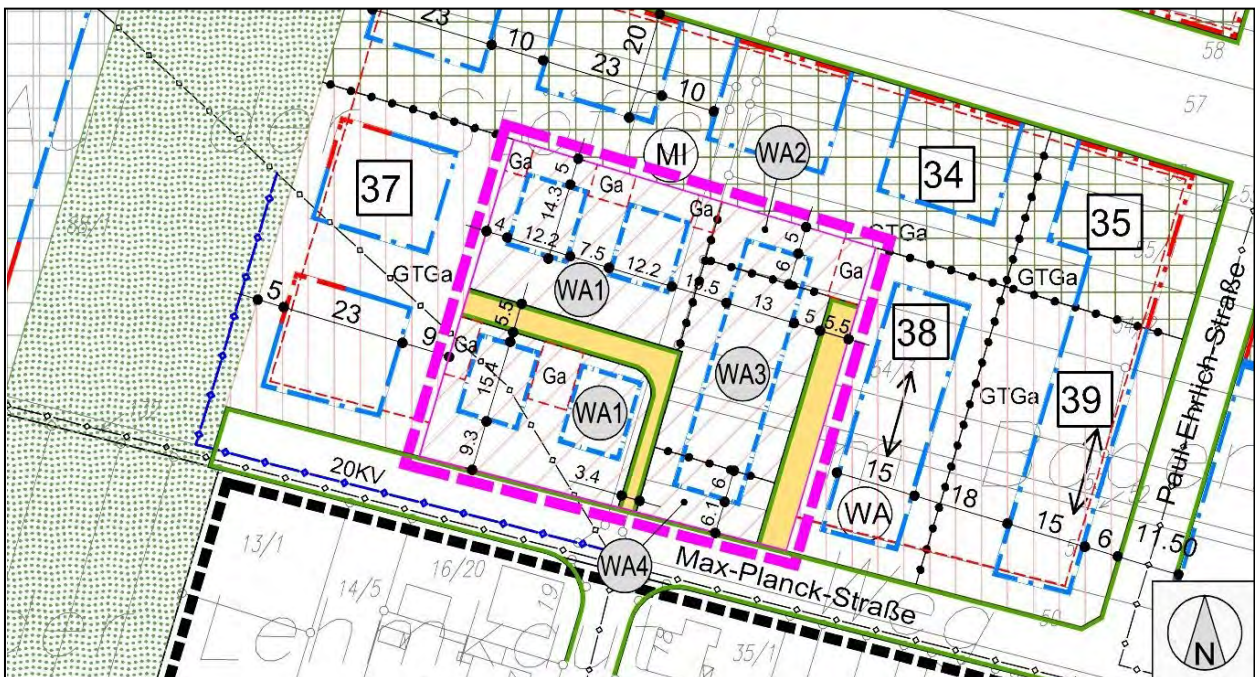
Vorhabenbezogener Bebauungsplan zur 4. Änderung des Bebauungsplans „Krebschere“
